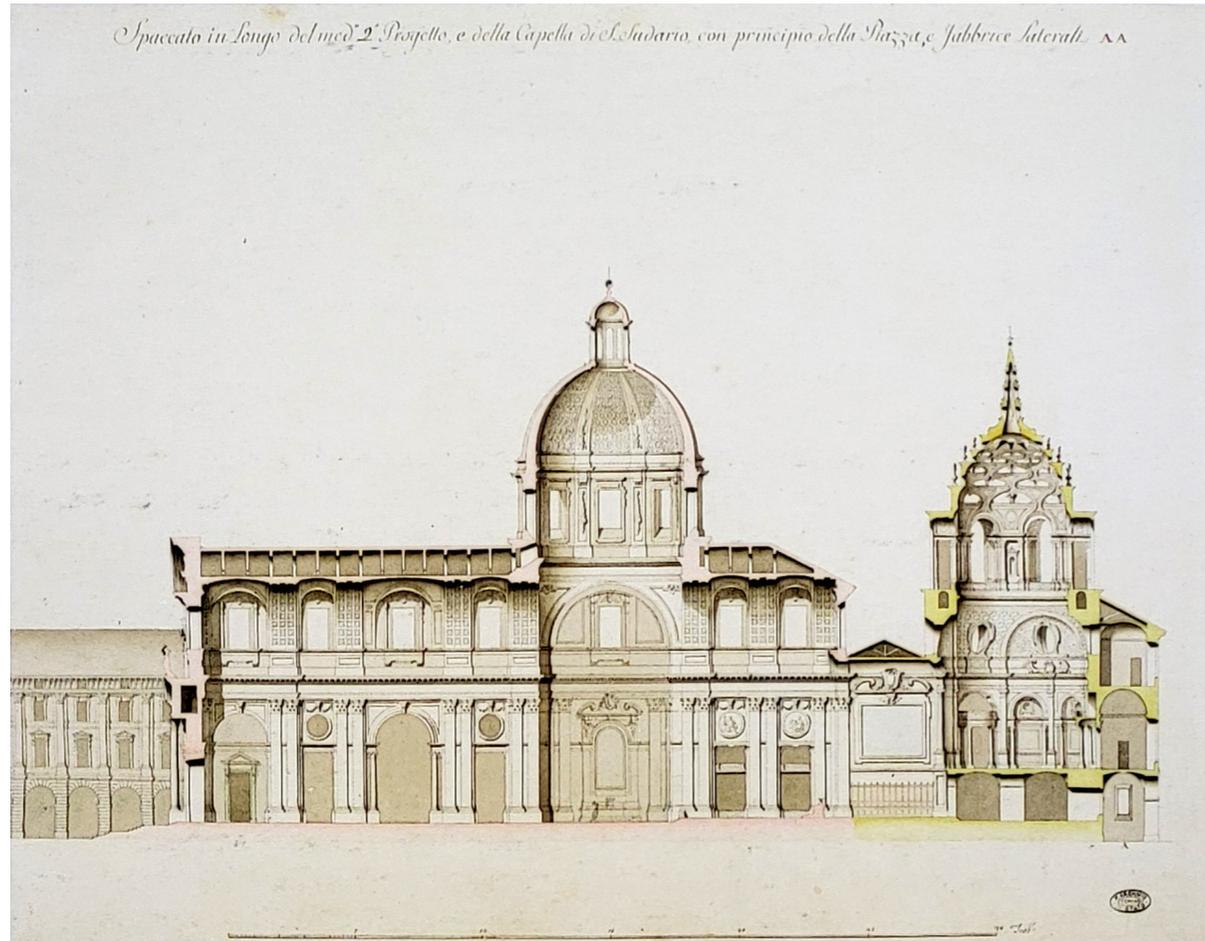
Secondo progetto del Duomo di Torino di Benedetto Alfieri, sezione
